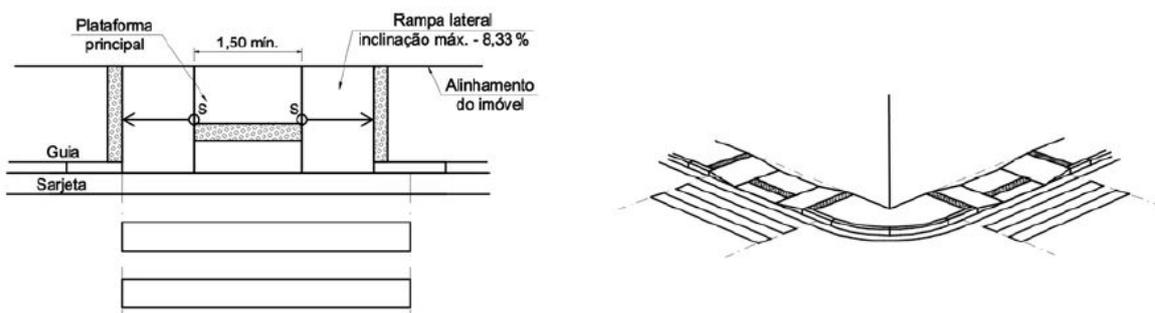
Tipo 3 de rebaixamento da calçada – passeios estreitos.
